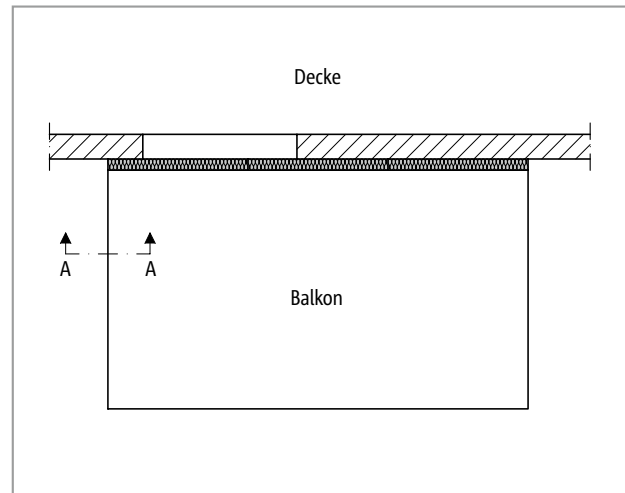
Schöck Isokorb® T Typ K: Darstellung der Lage von dem Schnitt A-A
